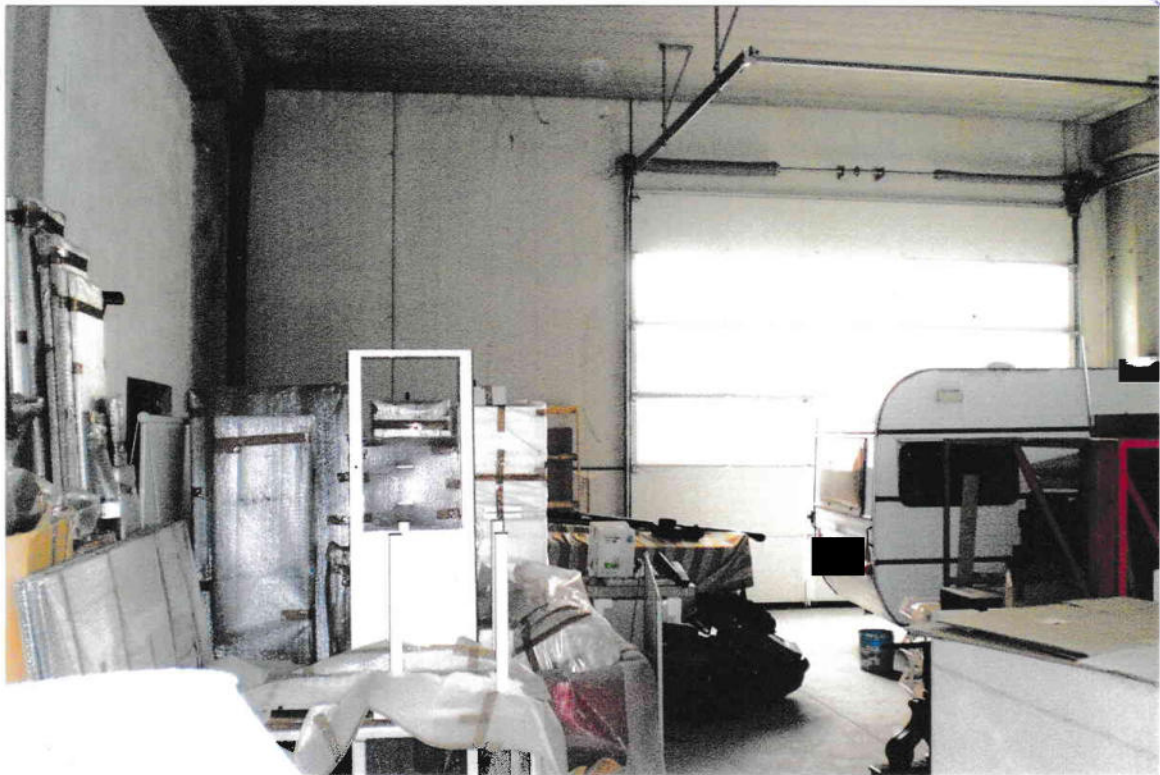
PARTICOLARE MAGAZZINO AL PIANO TERRA
